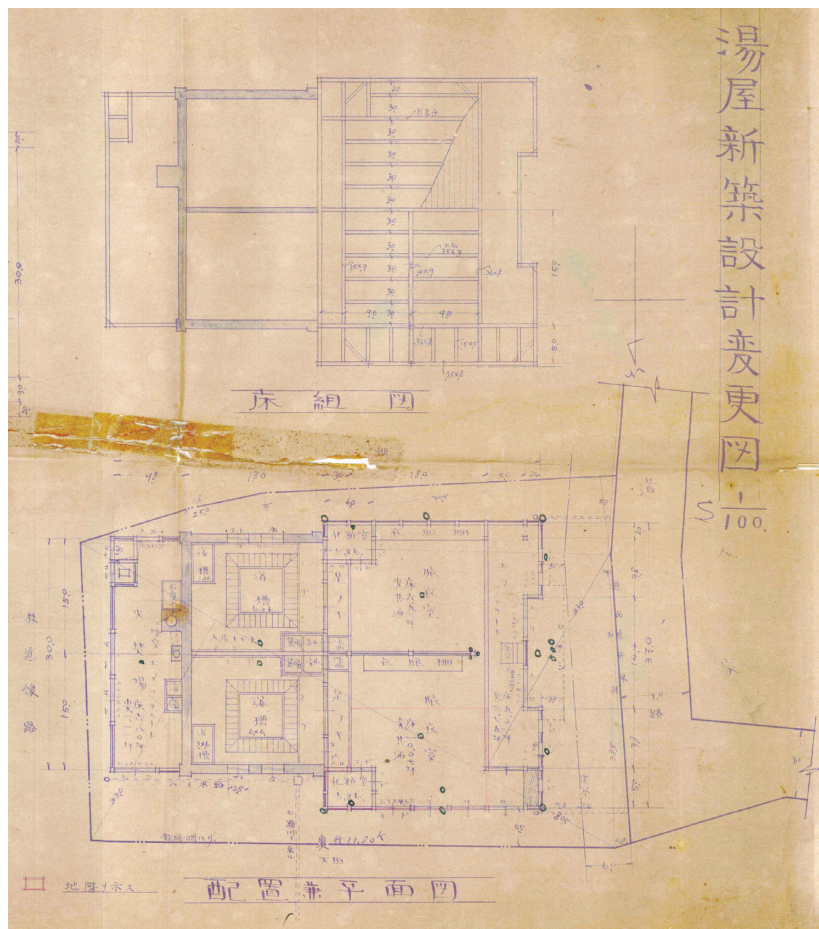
当初湯屋新築設計変更図 床組図 配置図及平面図
